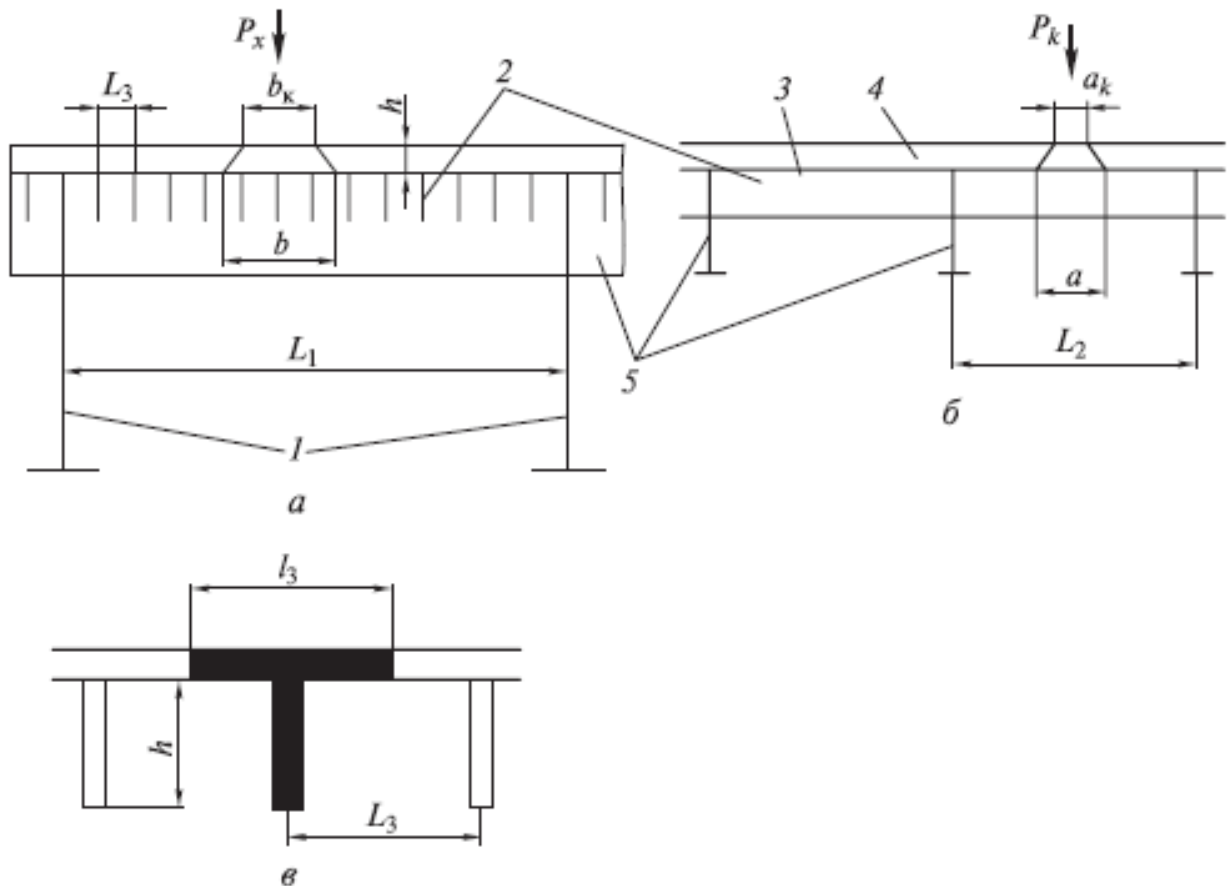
Взаимное положение главных балок и элементов ортотропной плиты и схема к определению расчетной ширины листа, включающегося в работу продольного ребра:
